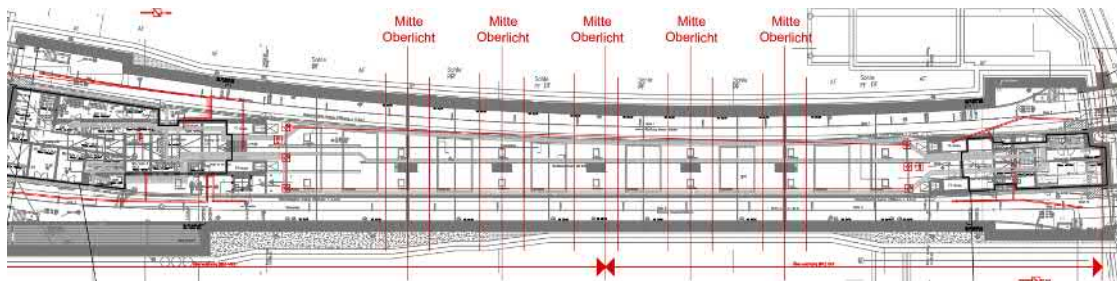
Grundriss mit Lage der Linearmelder
